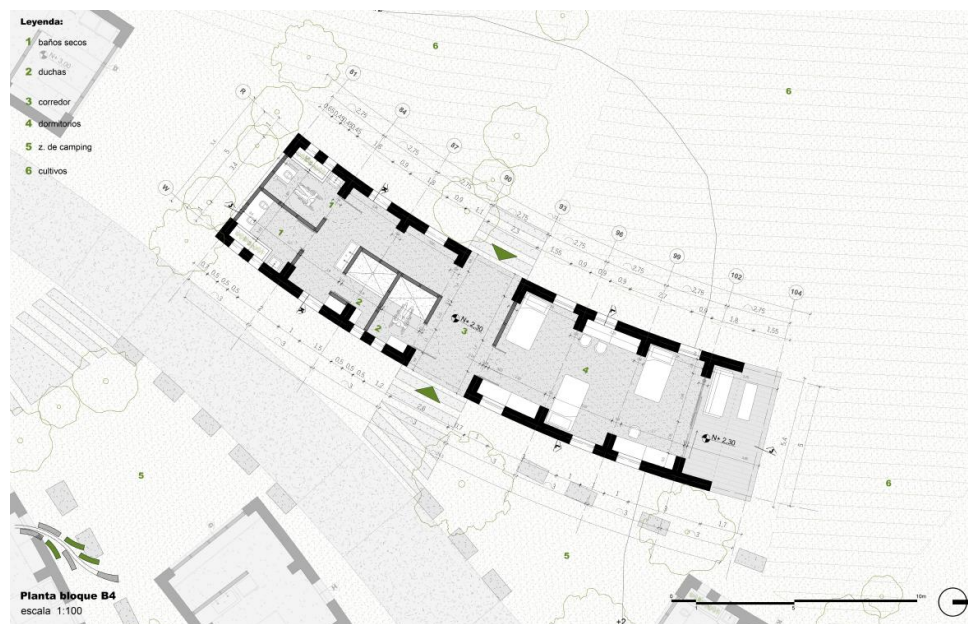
Planta tipo del bloque de descanso Fuente: Cristian Campaña, 2018
